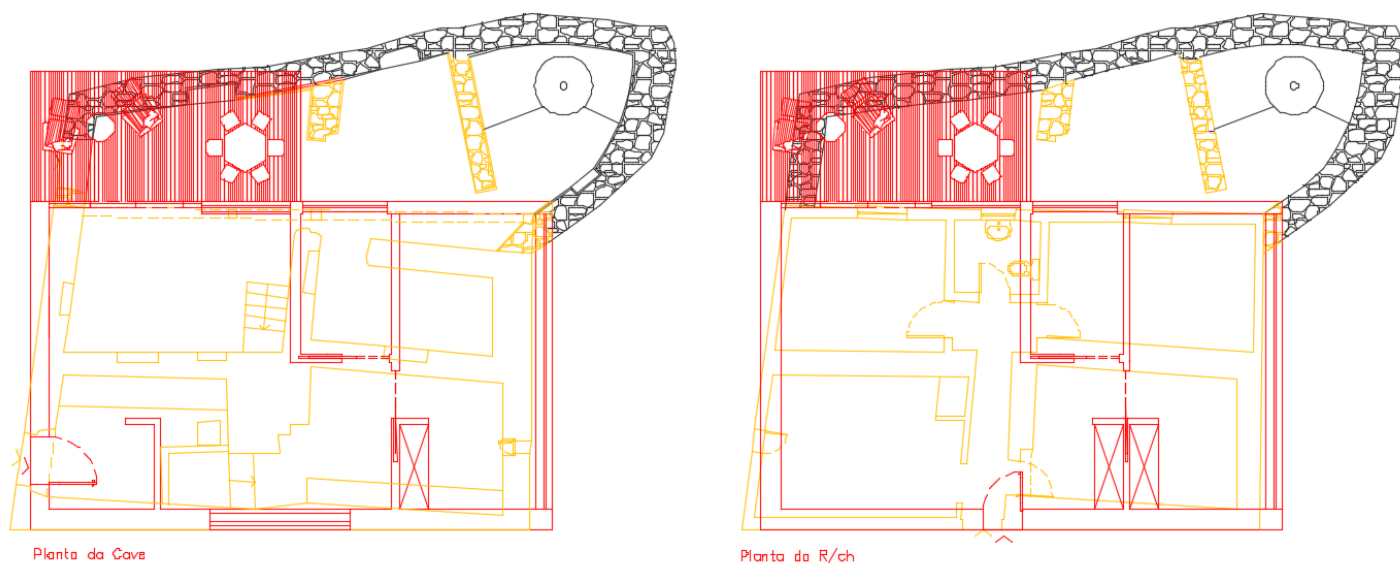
Casa 1: Planta de Trabalhos – Cave e R/Chão respetivamente. Esboço 3
